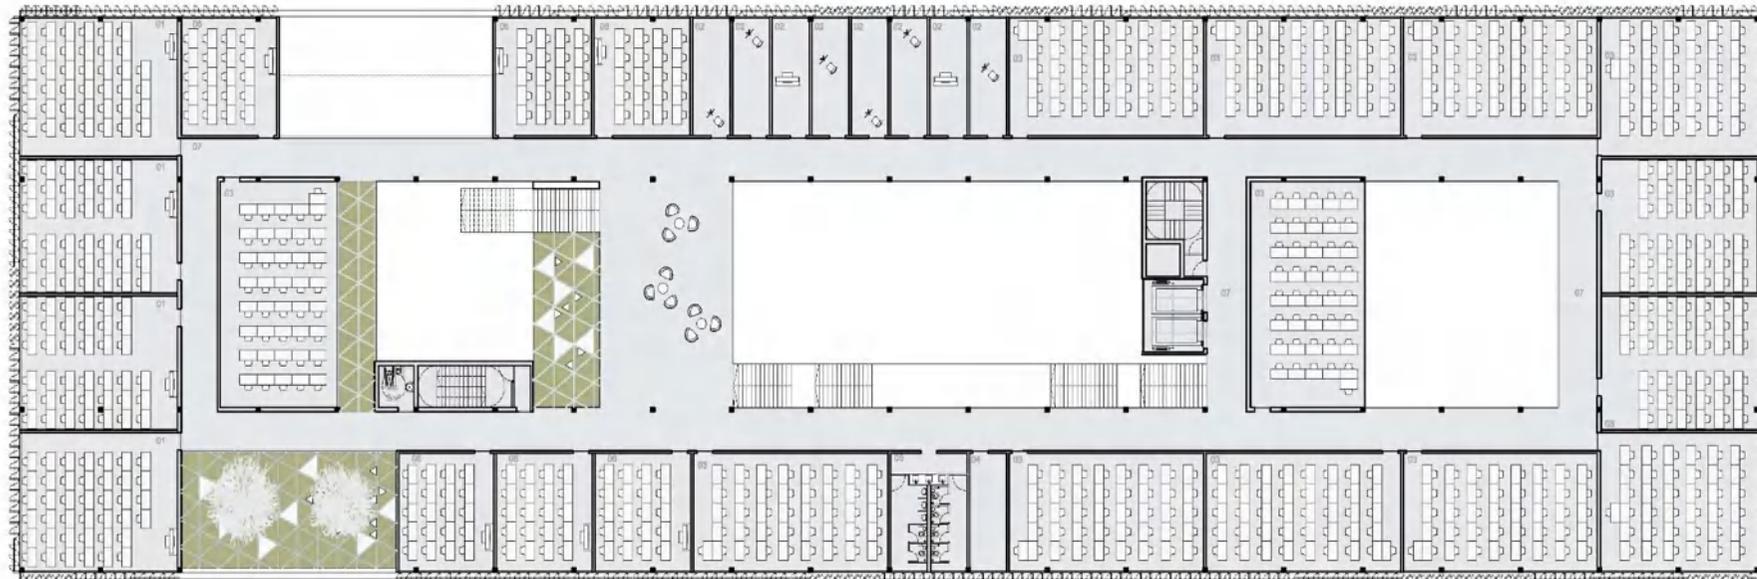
Planta baixa segundo pavimento do novo bloco Campus Cabral – UFPR (sem escala)
